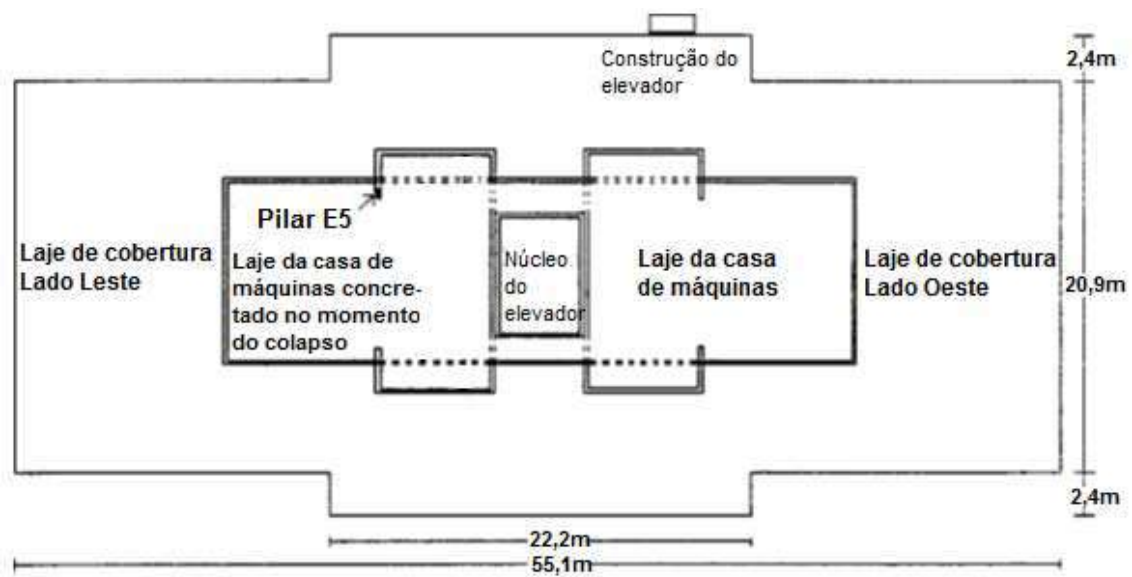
Planta da laje de cobertura do edifício em Boston (KING e DELATTE, 2004)
